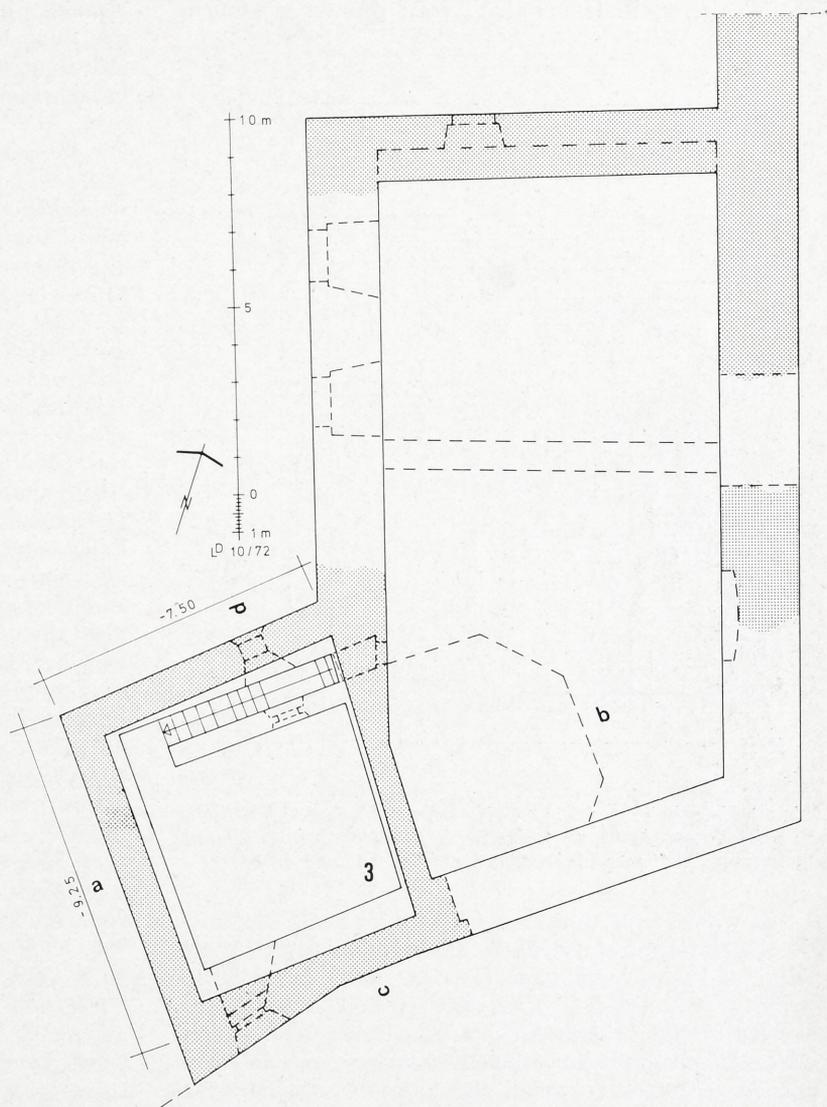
Krautheim a. d. Jagst. Burgruine. Obergeschoßgrundriß des Kapellenbaues (rekonstruiert) und Saalgeschoß des Palas. (Baufaufnahme und Zeichnung des Verfassers)
